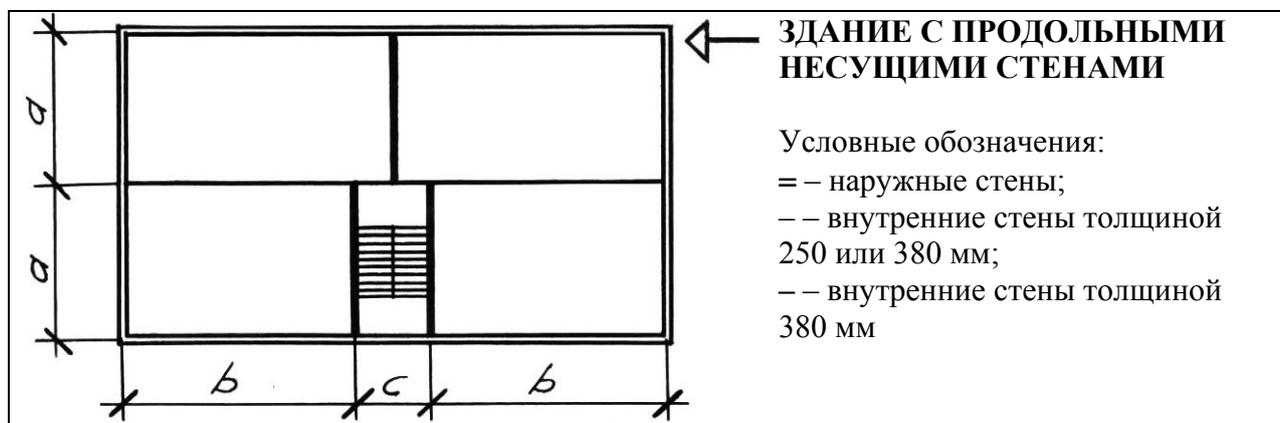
Схема плана здания с продольными несущими стенами
